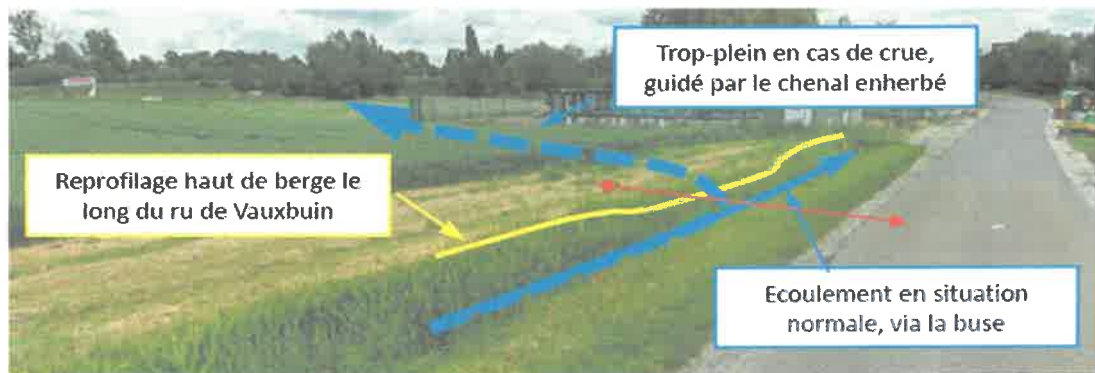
section de berge du ru de Vauxbuin modifiée (profils ci-dessous suivant flèche rouge), le long de la route D913
